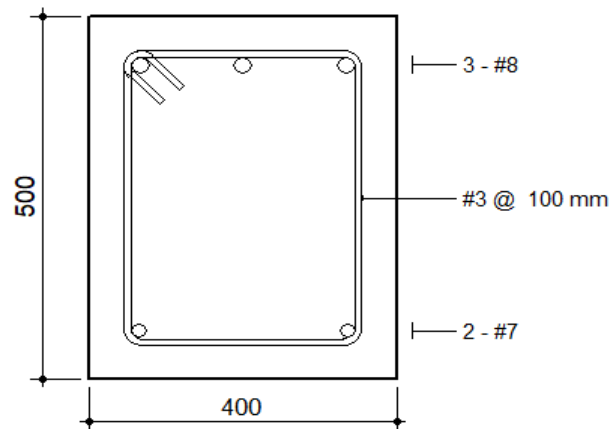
Sección de viga interior plantas 1, 2, 3 y 4. Fuente: Propia.
